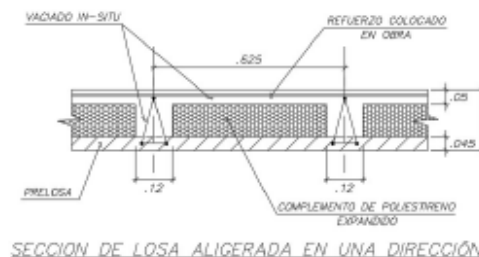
Detalle de losa aligerada en una dirección con prelosas.
